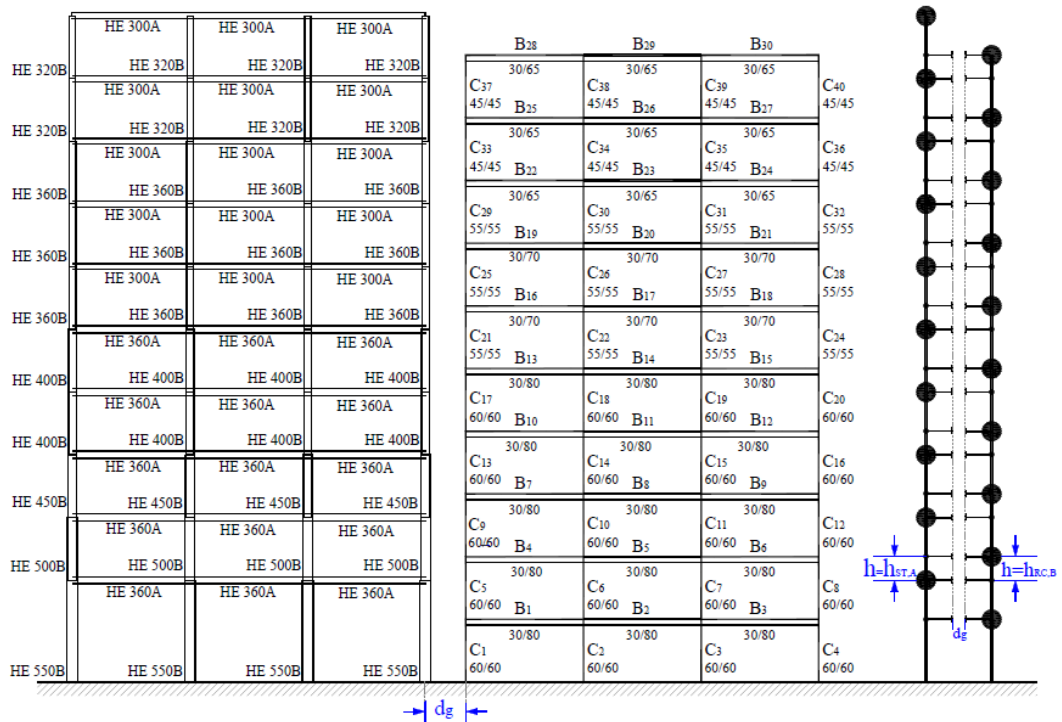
Estructura de acero de 10 pisos adosada a una estructura de hormigón armado de 10 pisos
